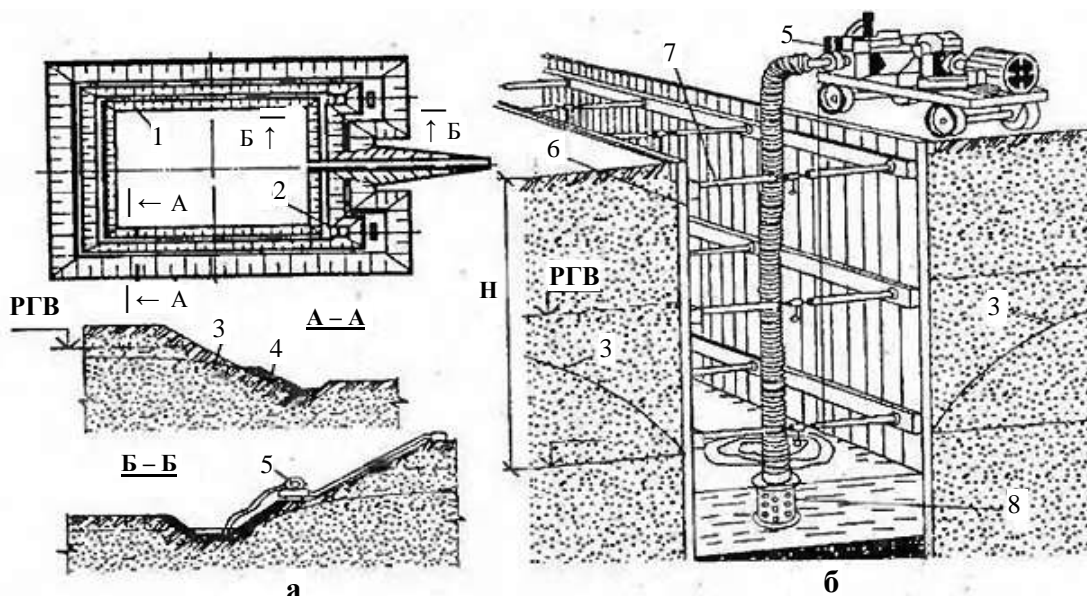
Схема відкритого водовідливу: а – з котловану; б – з траншеї; 1 – канава дренажна; 2 – прямок (зумпф); 3 – знижений рівень ґрунтових вод; 4 – привантаження дренажне; 5 – насос; 6 – кріплення шпунтові; 7 – розпірка інвентарна; 8 – рукав всмоктуючий з сіткою (фільтром); Н – висота всмоктування
